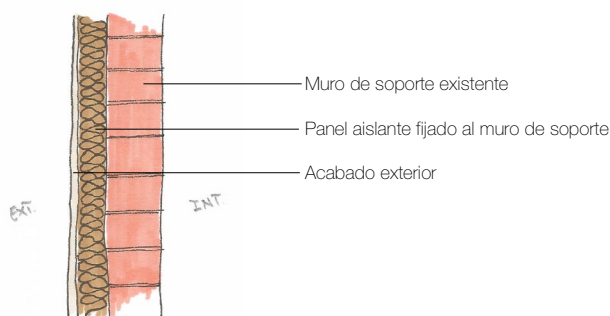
Detalle genérico en sección del Sistema Sate de cerramiento de fachada (autoría propia).
